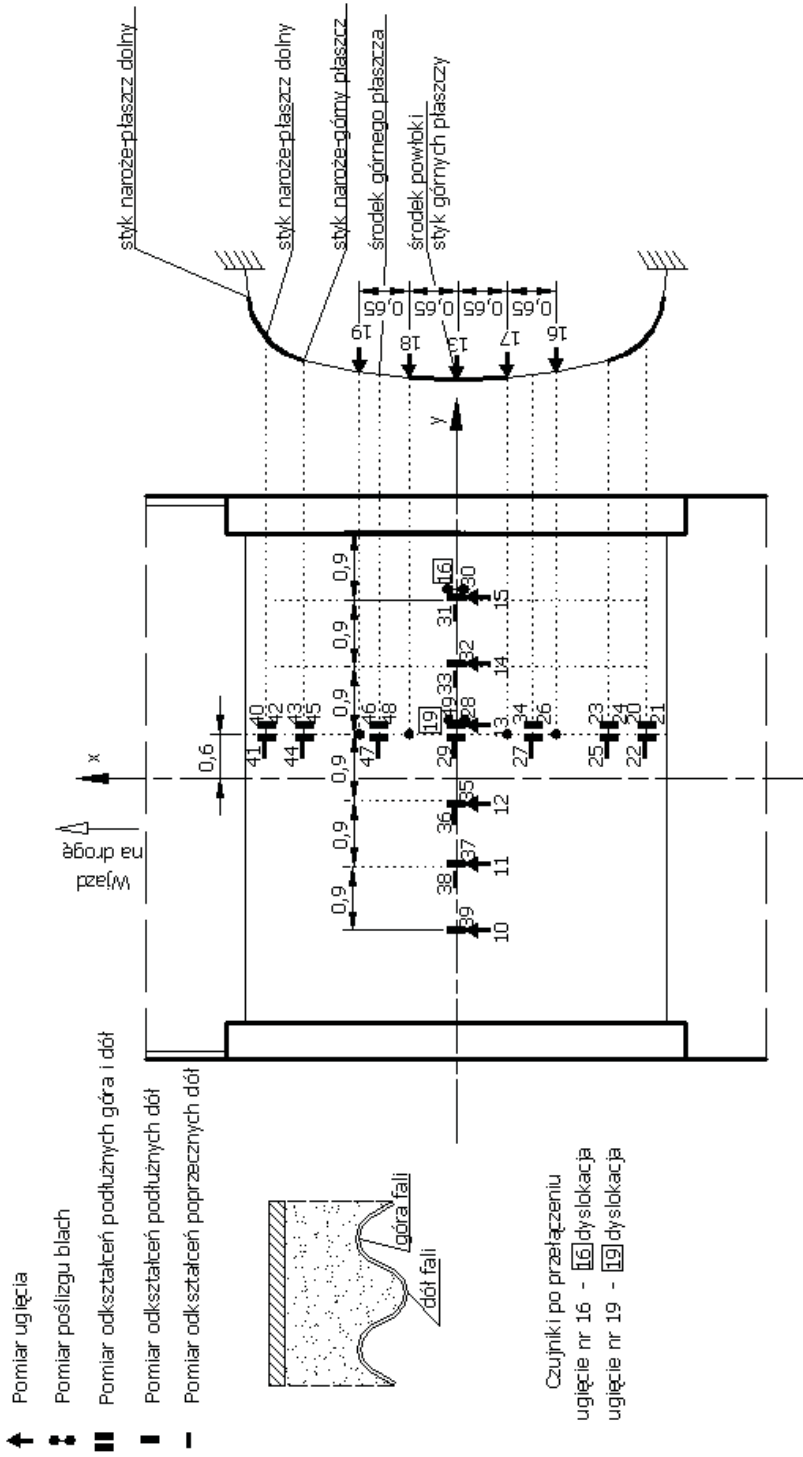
Schemat konstrukcji gruntowo-powłokowej
